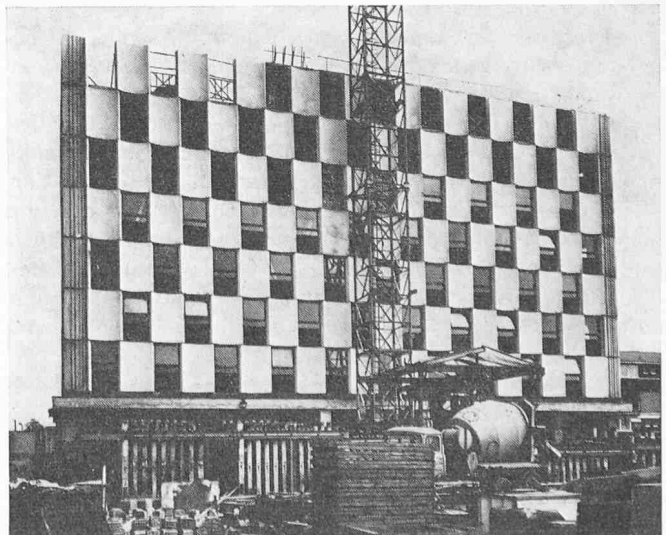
Verkleidung der Fassade eines Gebäudes im Norden Londons mit konkaven Platten. Im Vordergrund die Batterie zum Giessen der Platten an der Baustelle.
